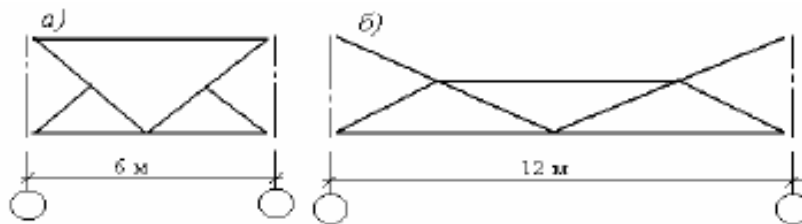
Схема вертикальних зв'язкових ферм покриття будівлі при відсутності (а) і наявності в ньому (б) наскрізних прогонів
